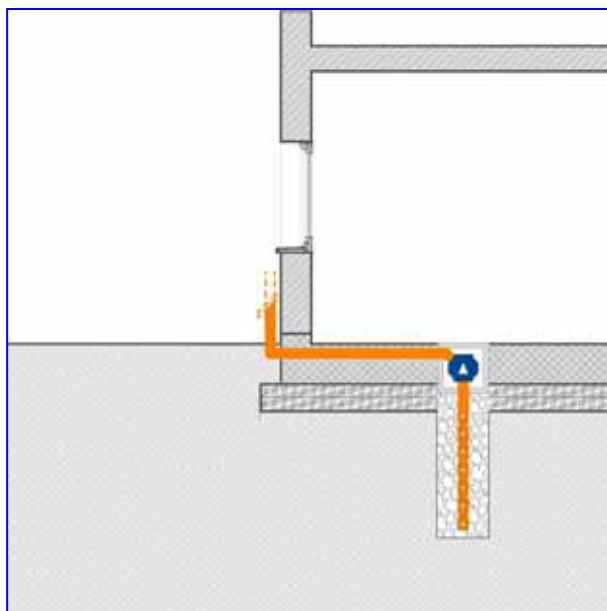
bonifica edilizia esistente ventilazione tramite pozzetto centrale o perimetrale
